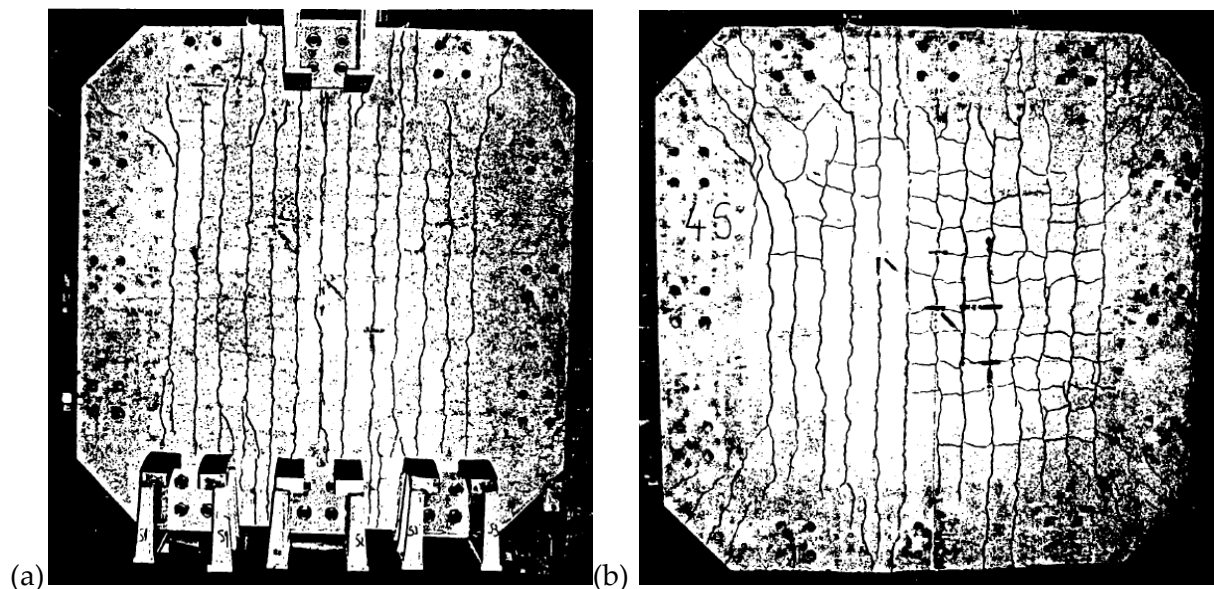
Faciès de fissuration pour des plaques en béton armé soumises à de la (a) flexion-bimembrane, (b) biflexion-bimembrane (Pascu 1995)
